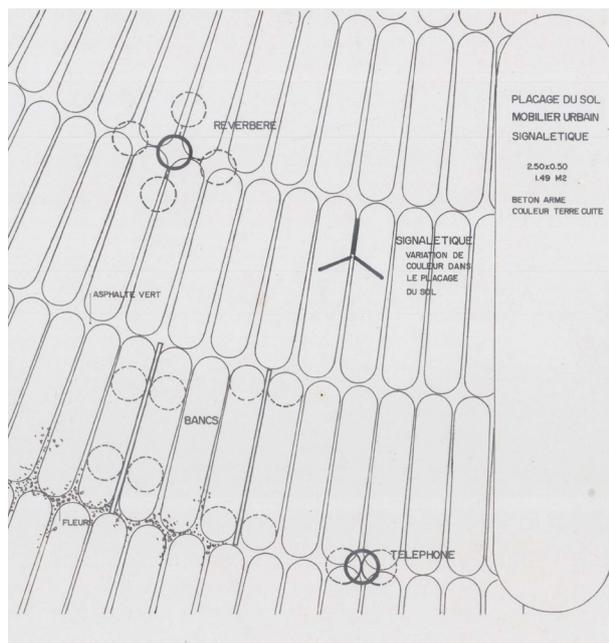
Detalhe da pavimentação em placas de betão armado, com implantação de sinalização, bancos, etc.
